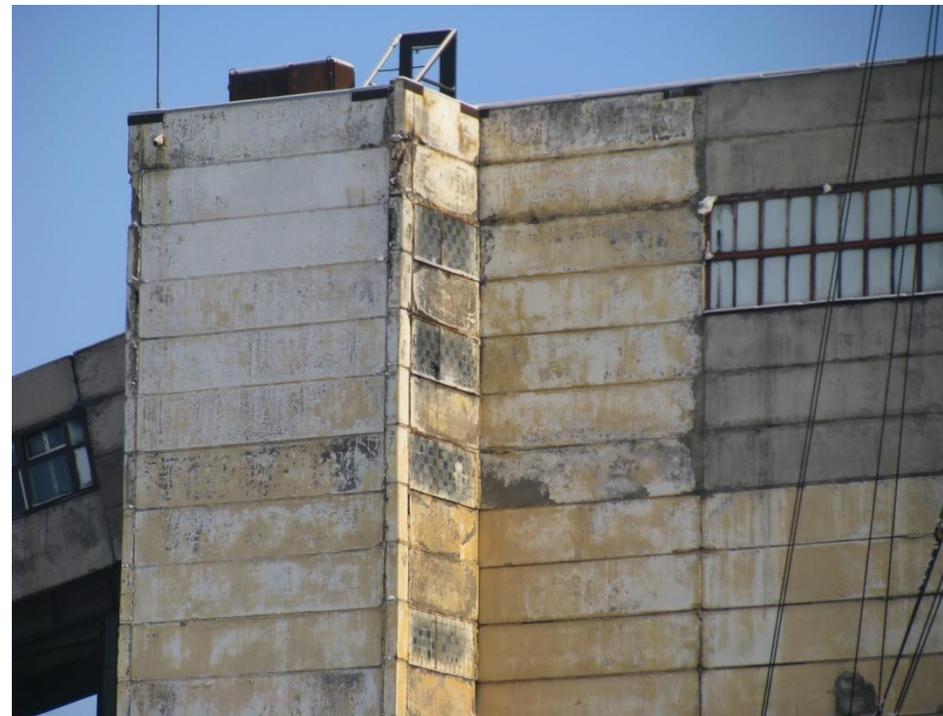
Разрушение железобетонных самонесущих навесных панелей здания котельной
